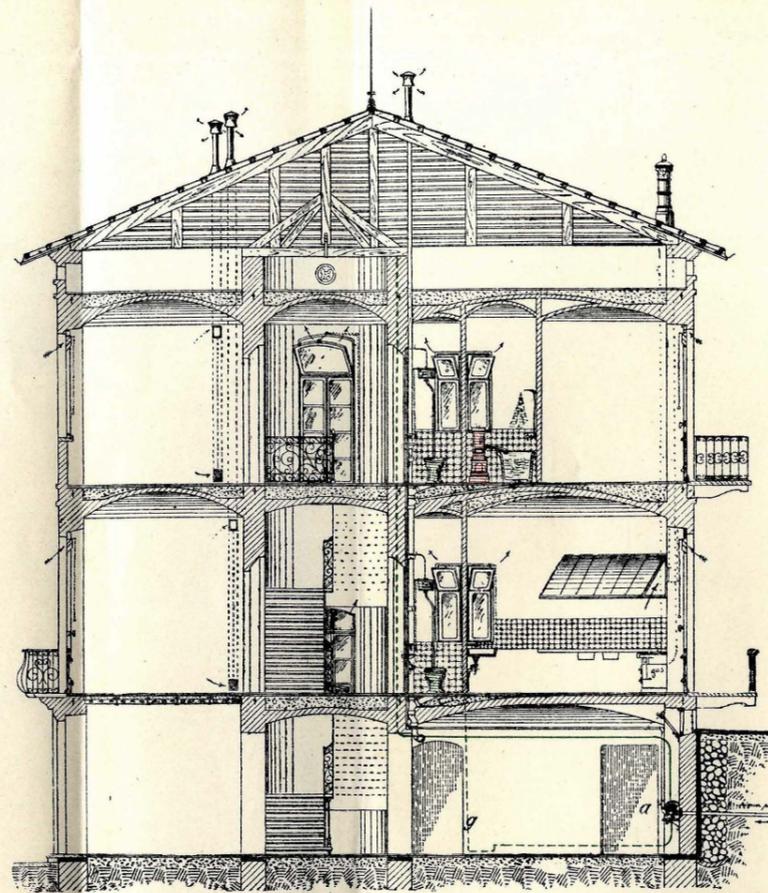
Sezione trasversale C-D (Scala 1:135).
